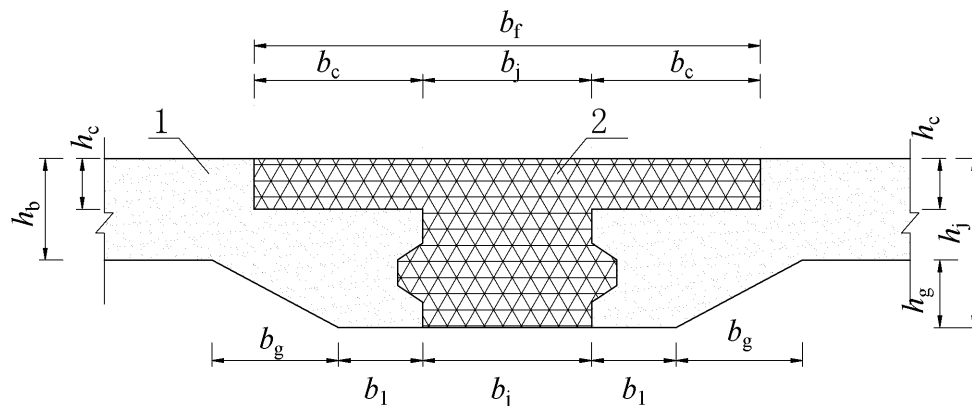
超高性能混凝土桥面板 T 形接缝方案
